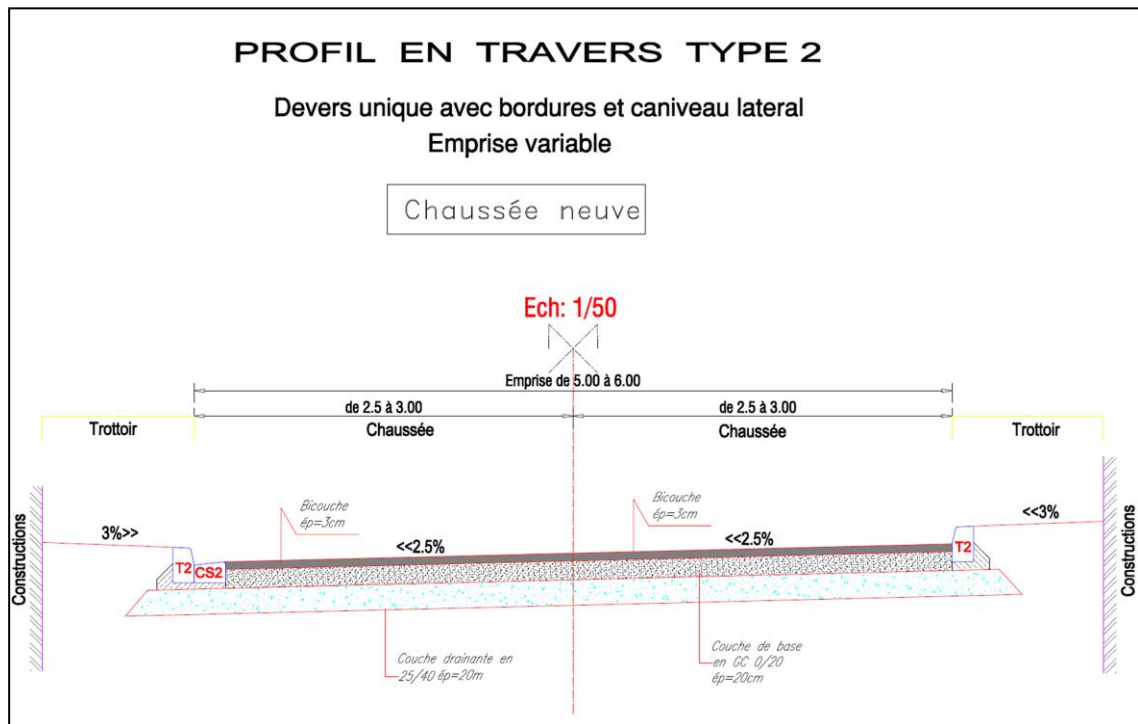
Coupe type du corps de chaussée-Aménagement type 2
